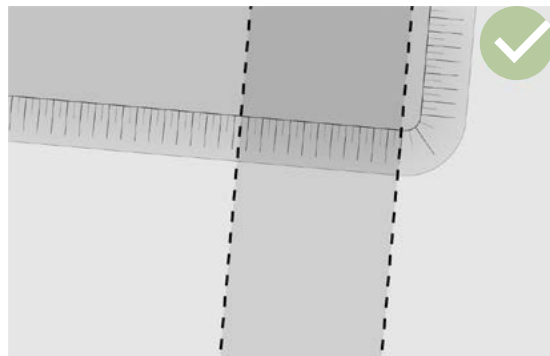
Principe: De brug dient te bestaan uit een slank betonnen dek op betonnen steunpunten. Opgaande constructieve elementen bovendeks zijn niet toegestaan (bijvoorbeeld een boog of tuien); bron: Michel Heesen
